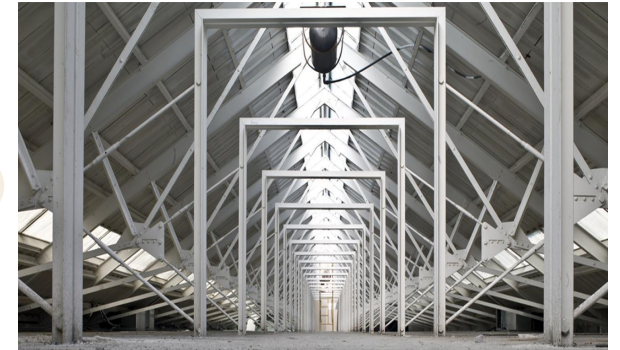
Vista de la estructura de la cubierta del laboratorio.
